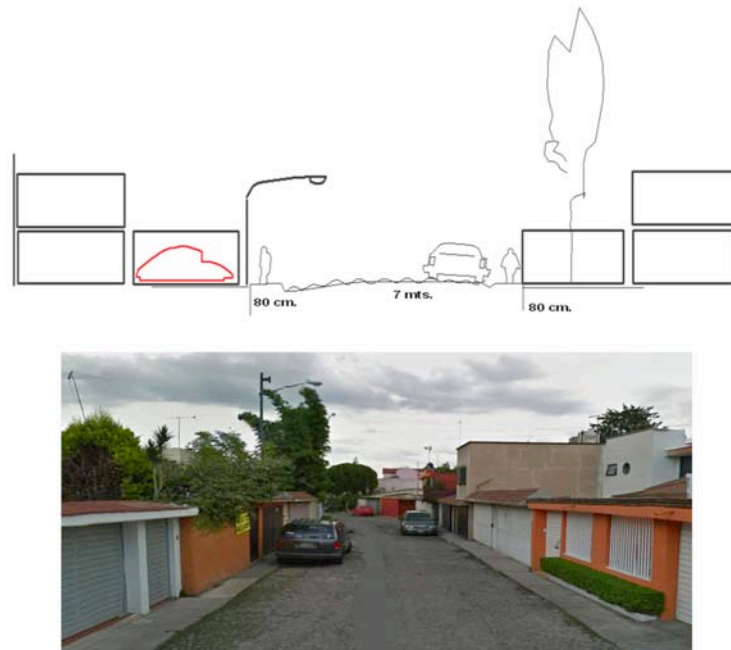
Perfil e Imagen de viviendas adosadas con fachadas modificadas.
